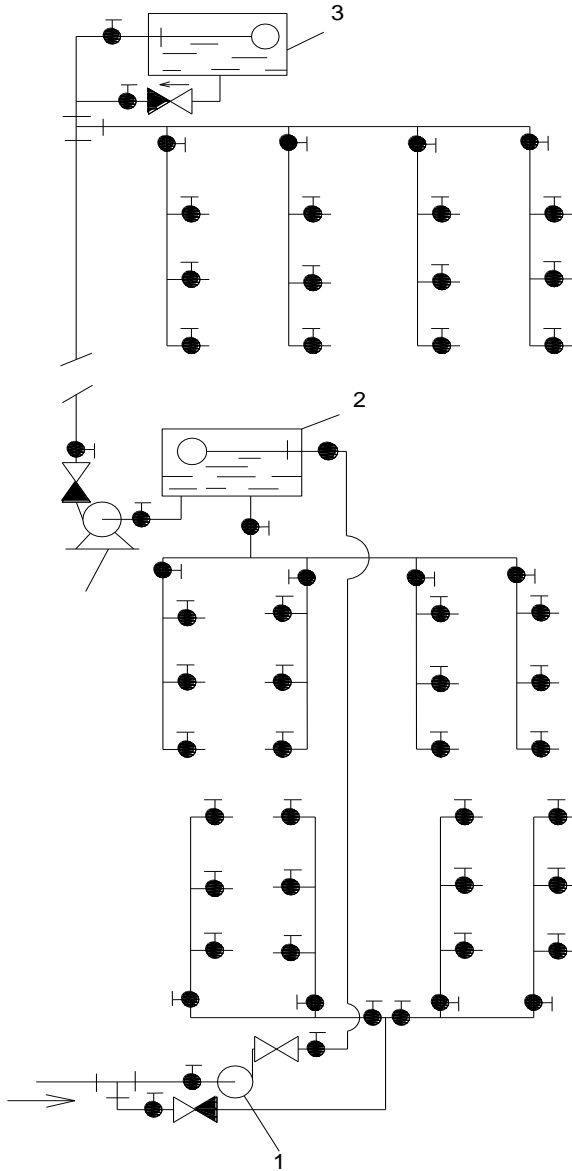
Последовательная схема зонных водопроводов зданий:
